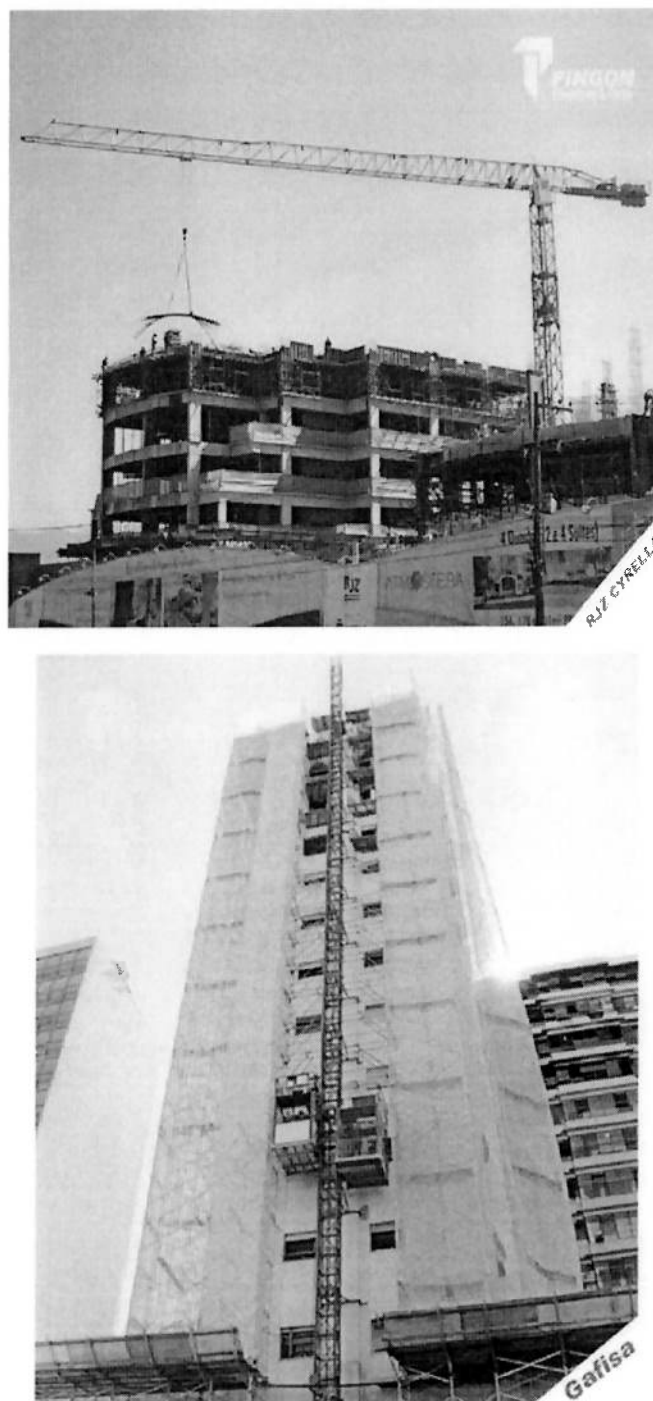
Modelo de Grua e Elevador de Carga (Pingon – Elevadores e Cargas, 2009).
